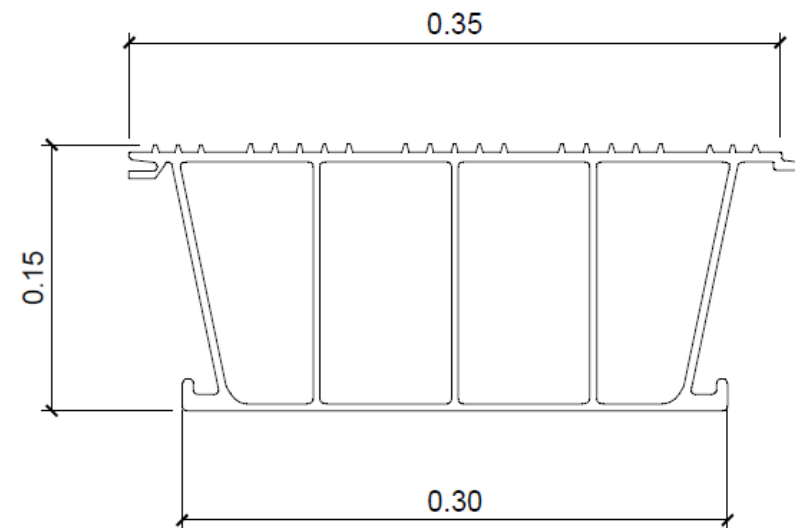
Panel de aluminio machihembrado AW 6063 T6. Fuente: Propia.
